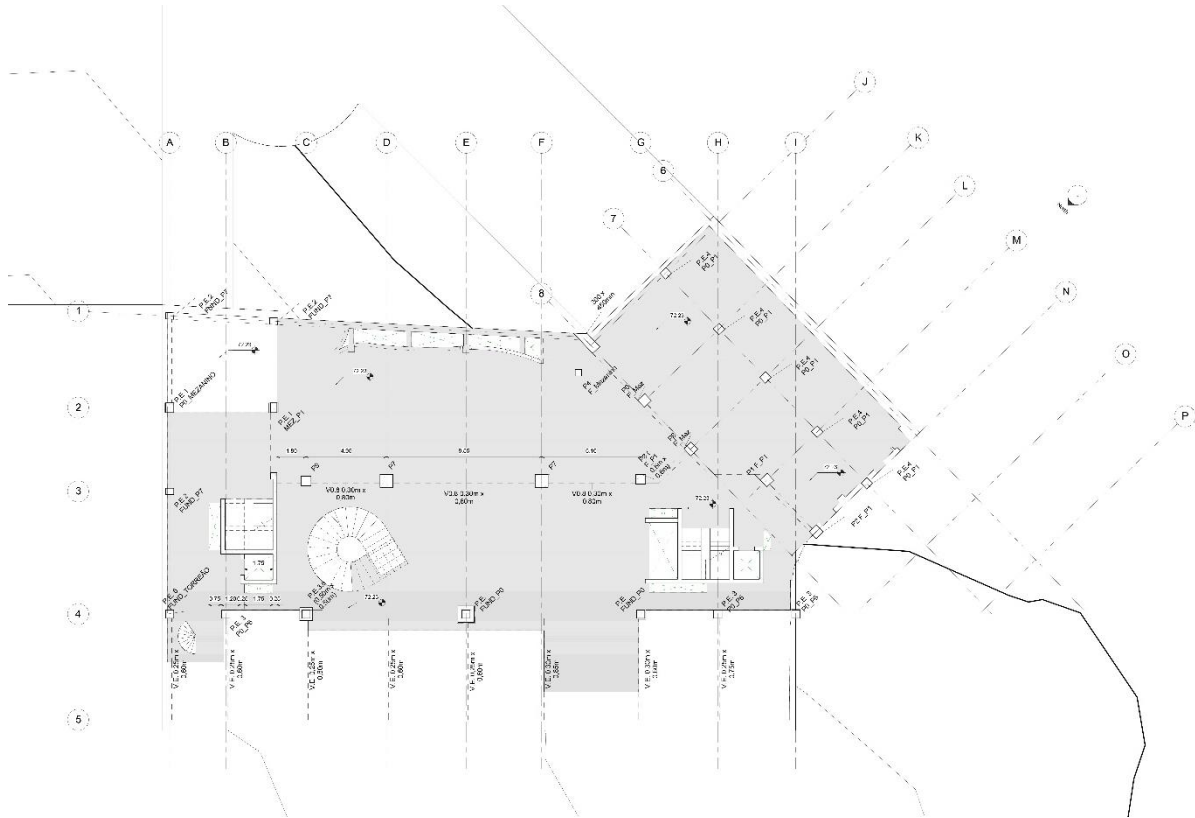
PLANTA DO PISO 0 EXTRAIDA DO MODELO BIM
